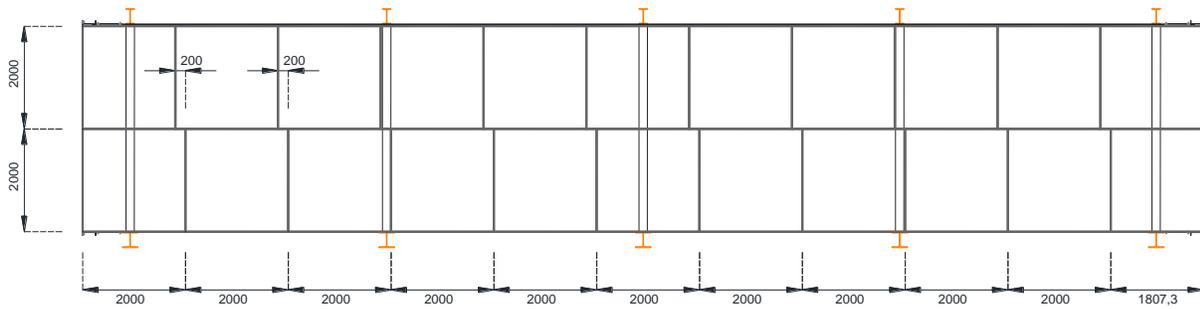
Juntas de expansión en techos de las zonas de radiación. Fuente: Planos del proyecto.
